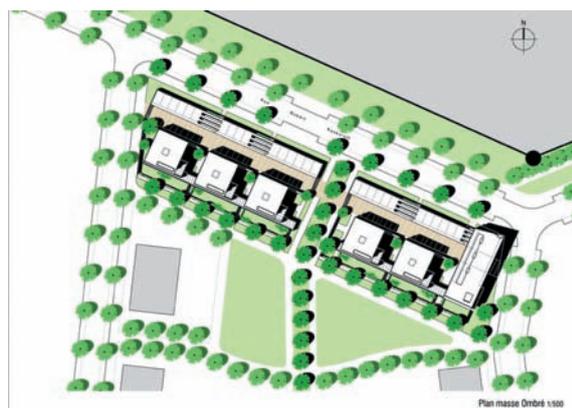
/ Opération de Caen : L'implantation de l'opération de Caen est face à la prison, et à côté d'une station essence. Cet environnement a dicté le plan masse : les garages servent de tampon entre les immeubles villas et la prison ; un petit collectif vert isole la parcelle de la station essence.
